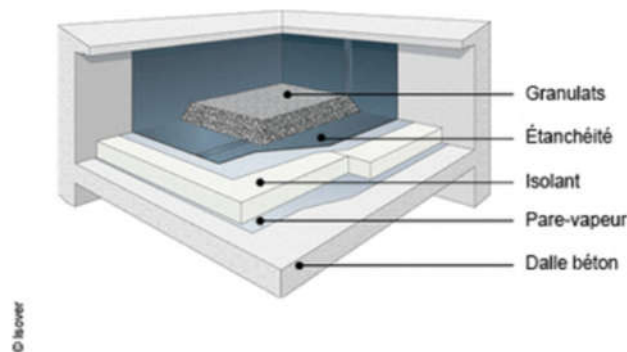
PLANCHER TERRASSE INACCESSIBLE
